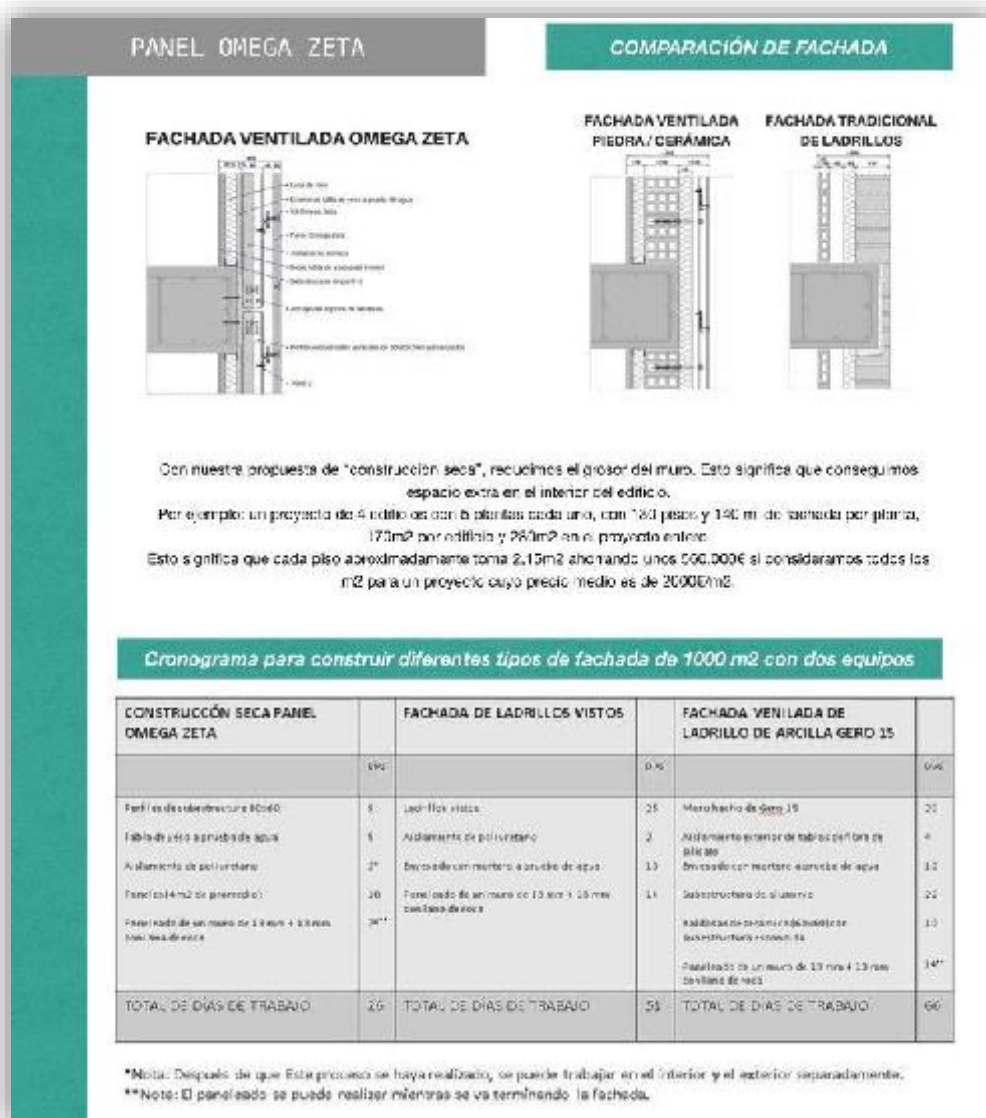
Aspecto tecnológico constructivo - comparación de fachadas ventiladas
